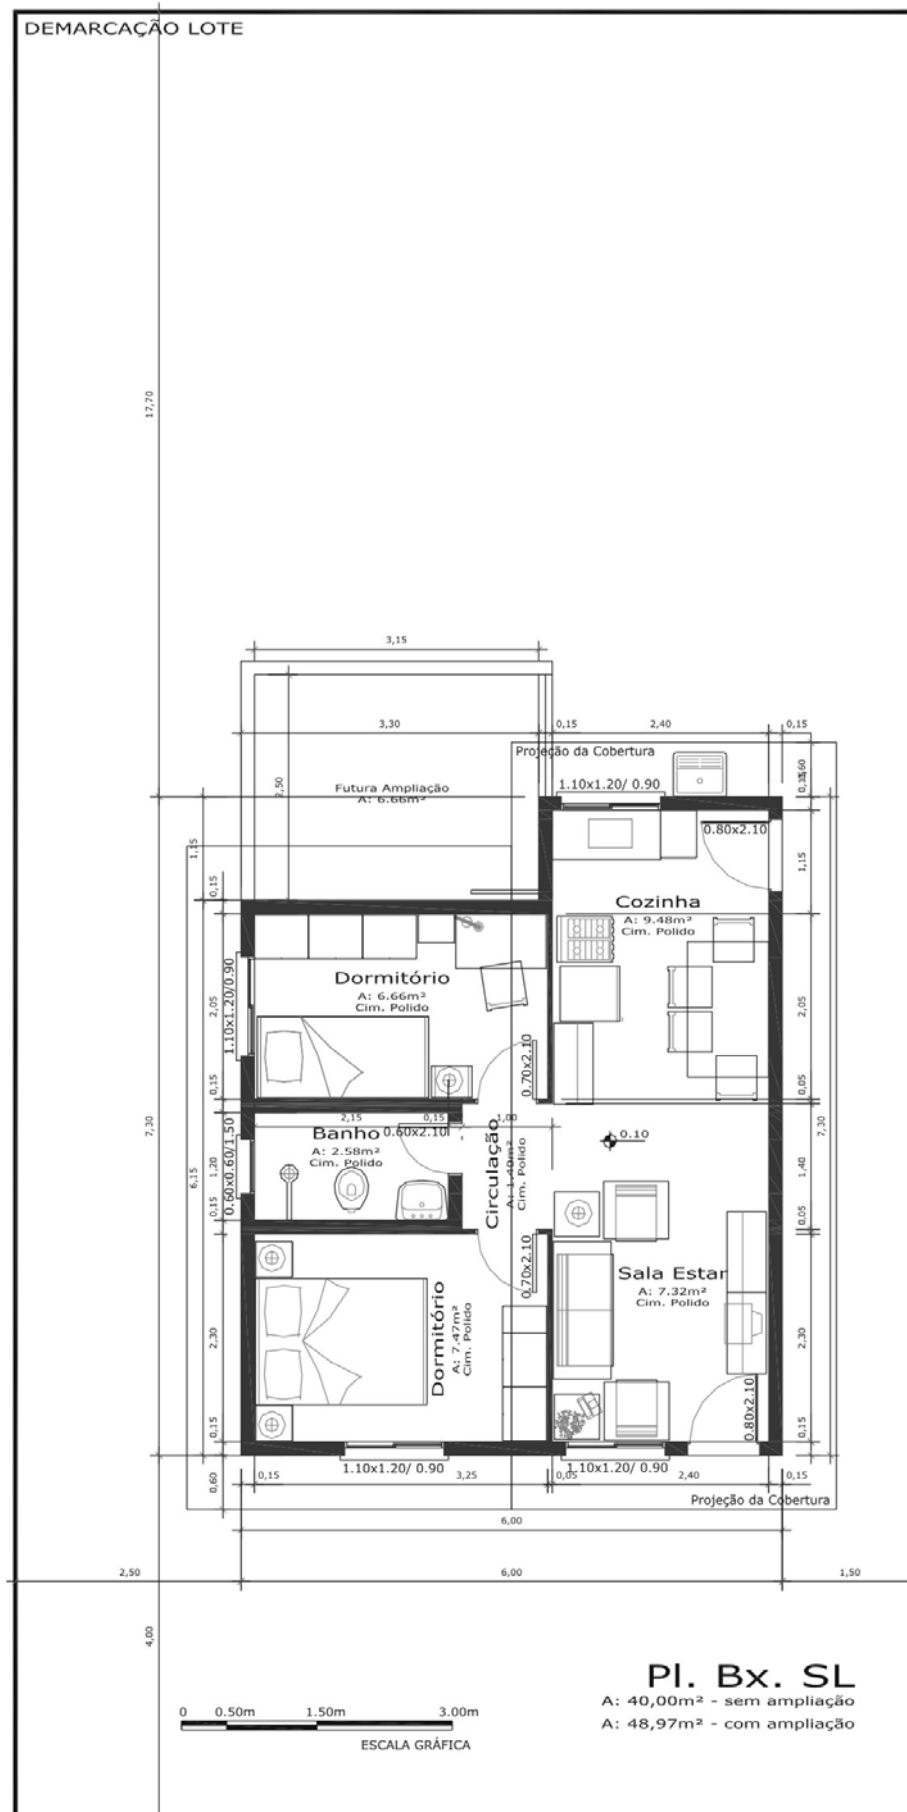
Sistema Construtivo Misto, Planta Baixa – Área: 40,00 m².
